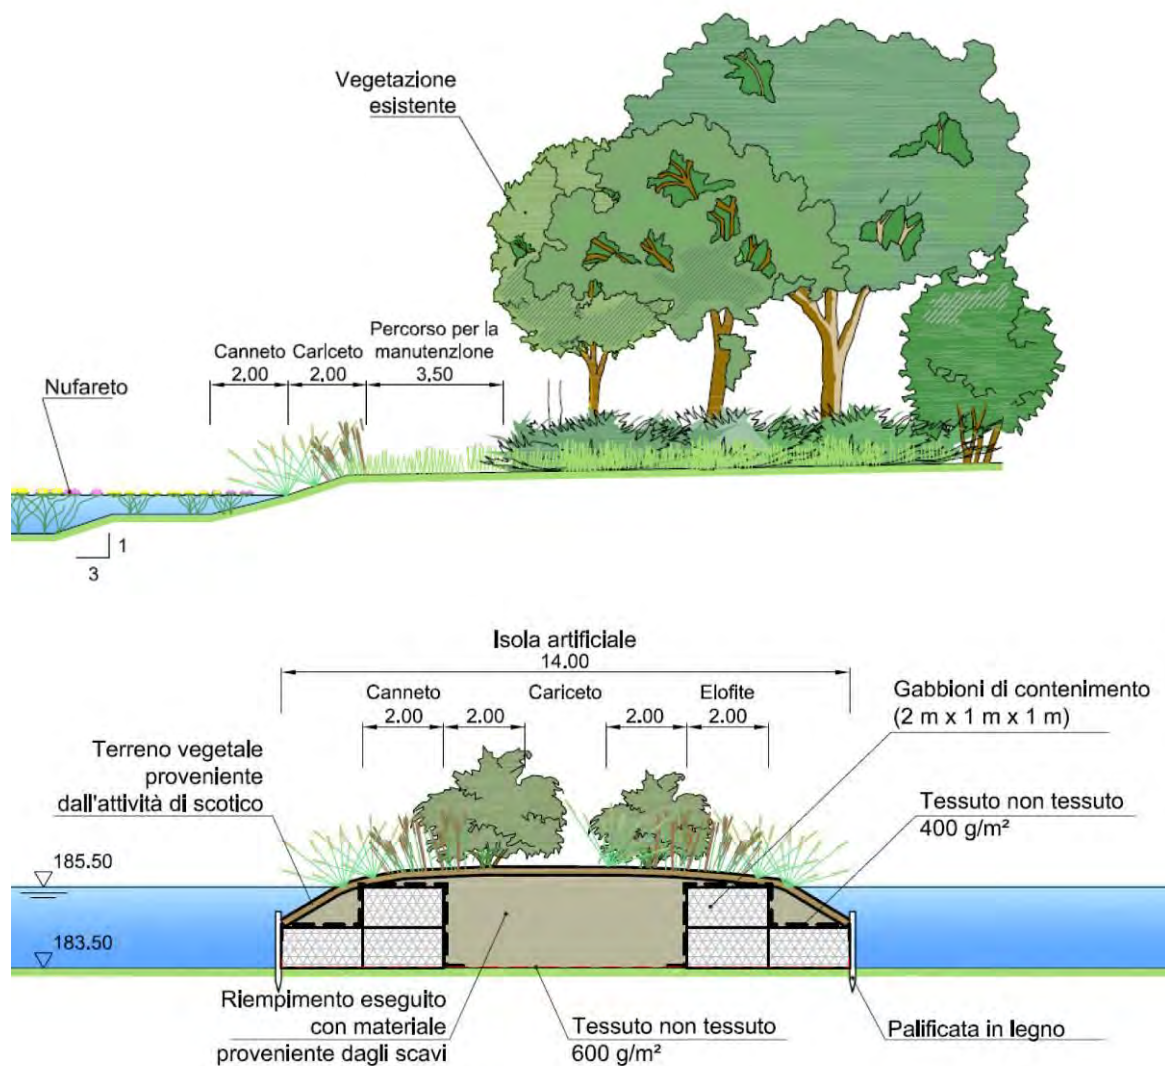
La Foppa: Sezione della sistemazione spondale e dell'isola artificiale.
